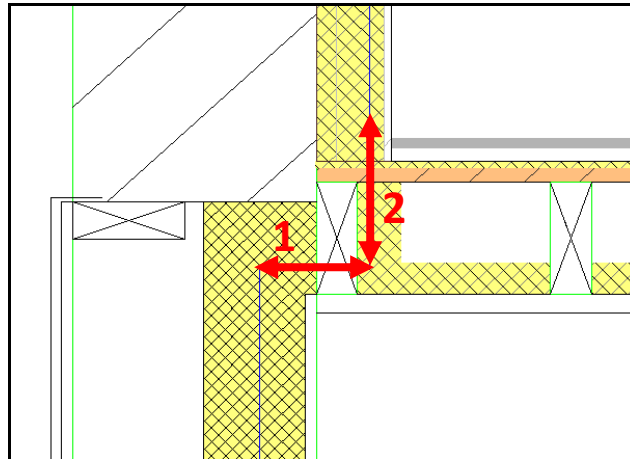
Détail du nœud de jonction des caissons isolés avec l'isolant en façade
